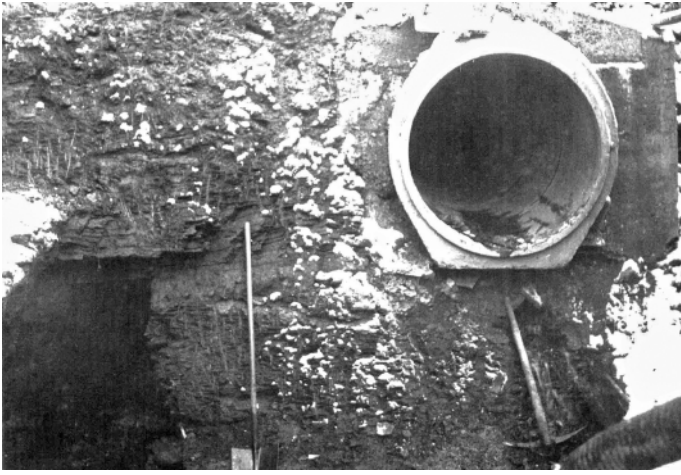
Baugrube für einen Quell- und Einstiegsschacht des Bachdurchlasses im Zuge der Hengsteystrasse. Links im Bild ein angeschnittener Stollen (BILFINGER & BERGER 1929)
